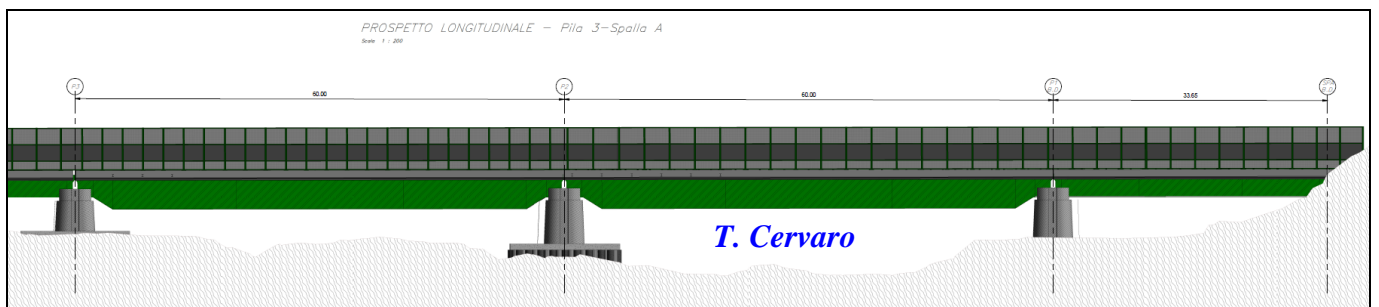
Prospetto (Pila 3 – Spalla A) del viadotto in progetto sul T. Cervaro.
